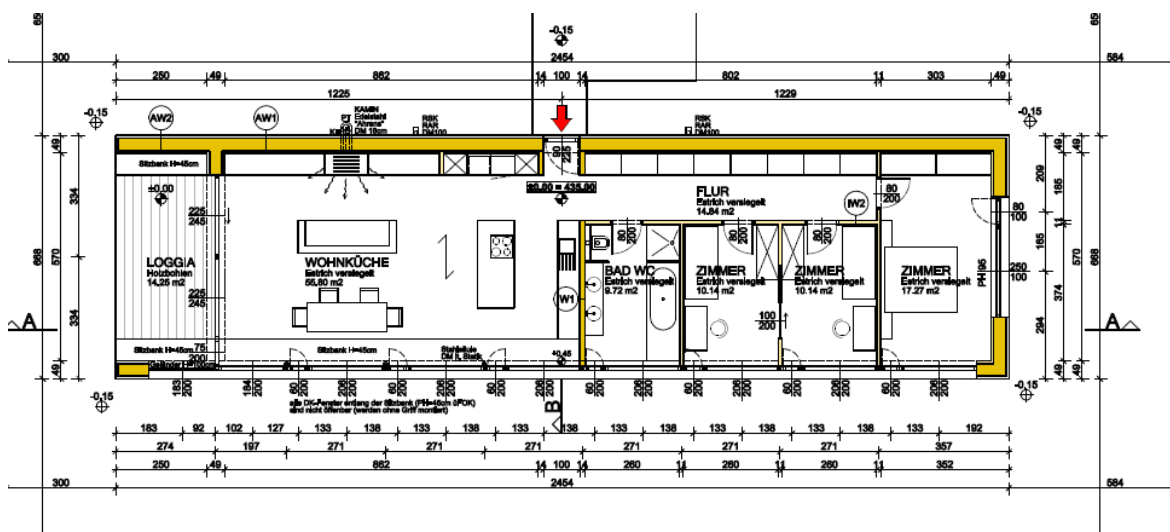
Grundriss Einreichplan Musterhaus
